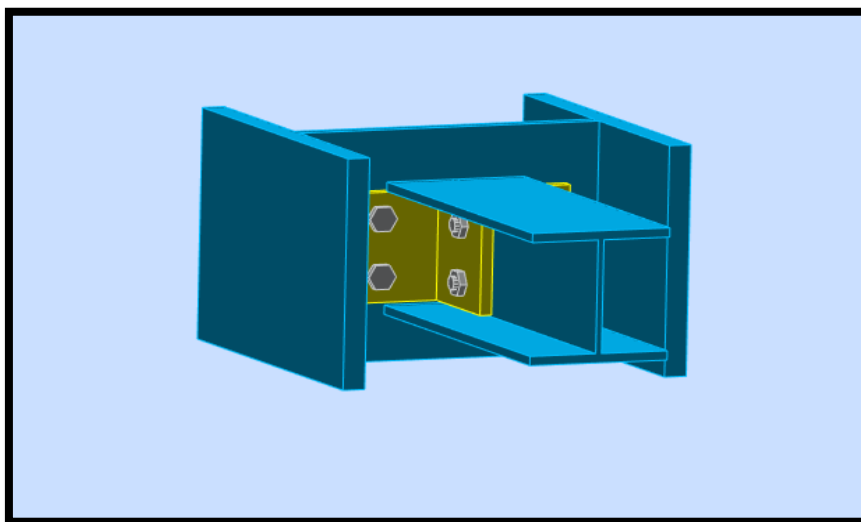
Représentation de l'assemblage poutre-poteau (âme).
